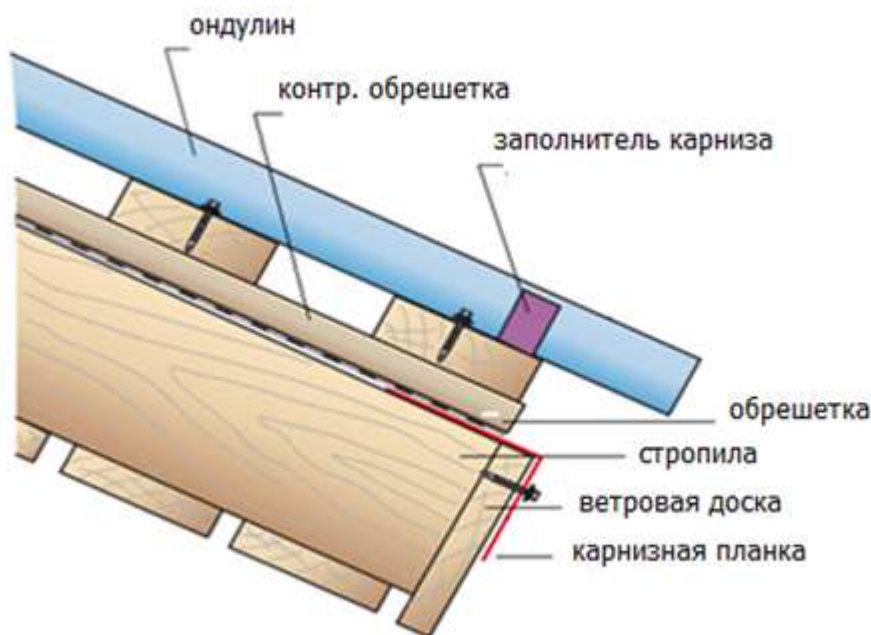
Устройство карнизного свеса кровли из ондулина
